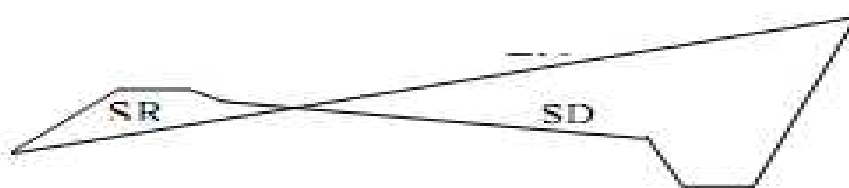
SURFACES DES DEBLAIS ET REMBLAIS
